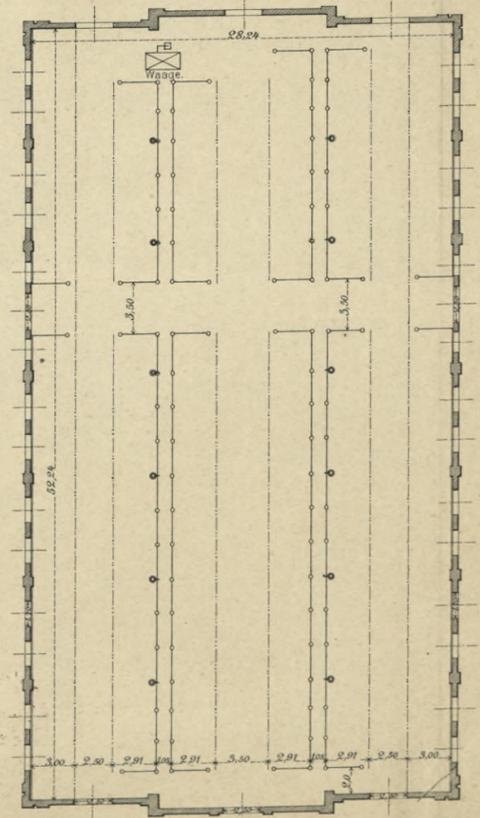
Grundriss der Markthalle für Großvieh 1:400.
